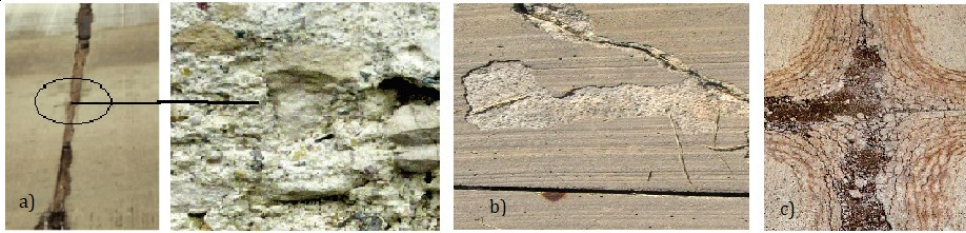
a) Deteriorarea betonului la rosturi; b) Exfolierea; c) Fisurarea sub forma de "D-cracking"
